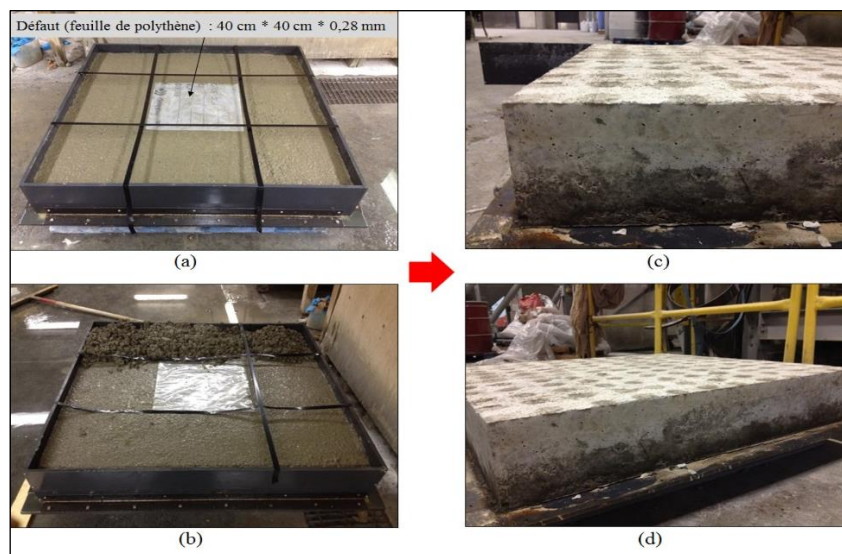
Dalle N° 2, (a) Mise en place du défaut, (b) remplissage du béton, (c) et (d) dalle monolithique.
